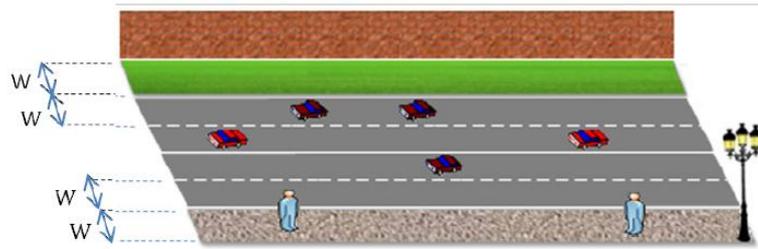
Parede a obstruir a faixa longitudinal exterior de largura w [2]
